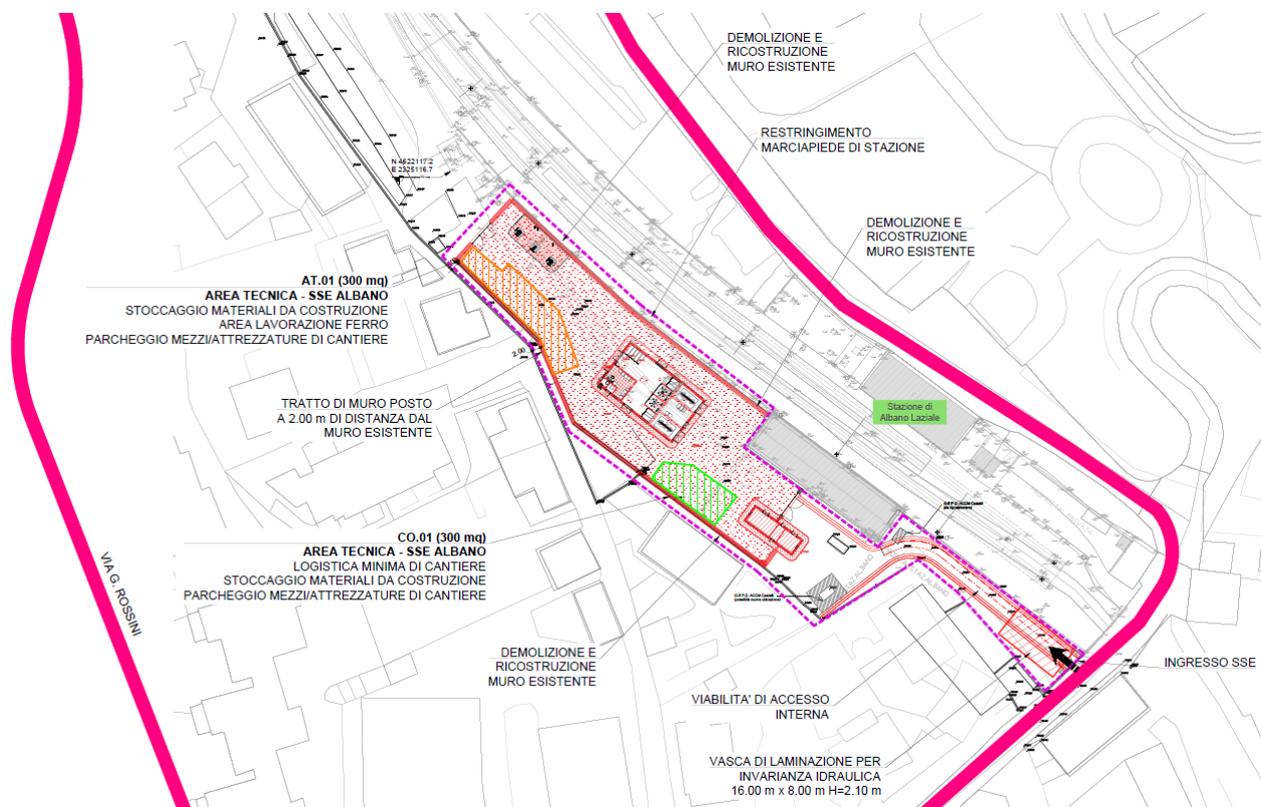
Planimetria di inquadramento della cantierizzazione. Fonte "Cantierizzazione" allegato alla Lista di Controllo
